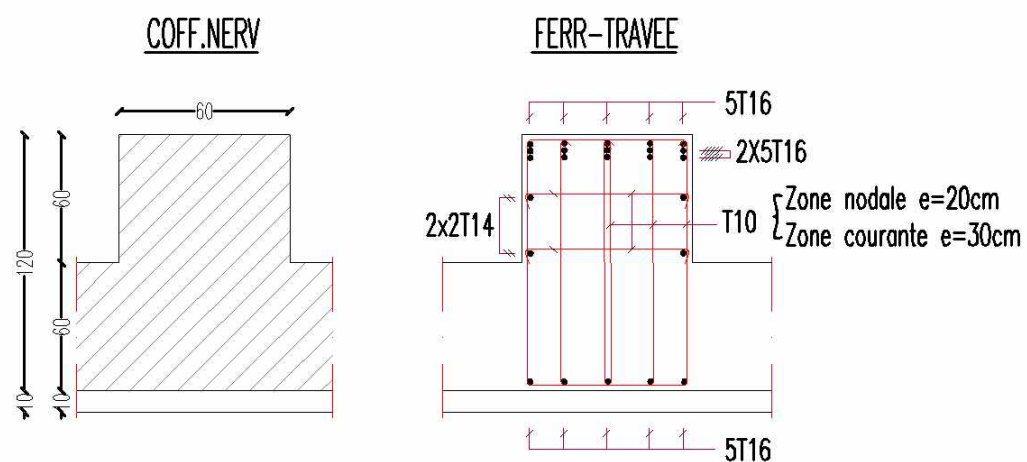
Schéma de ferrailage des nervures en travée
